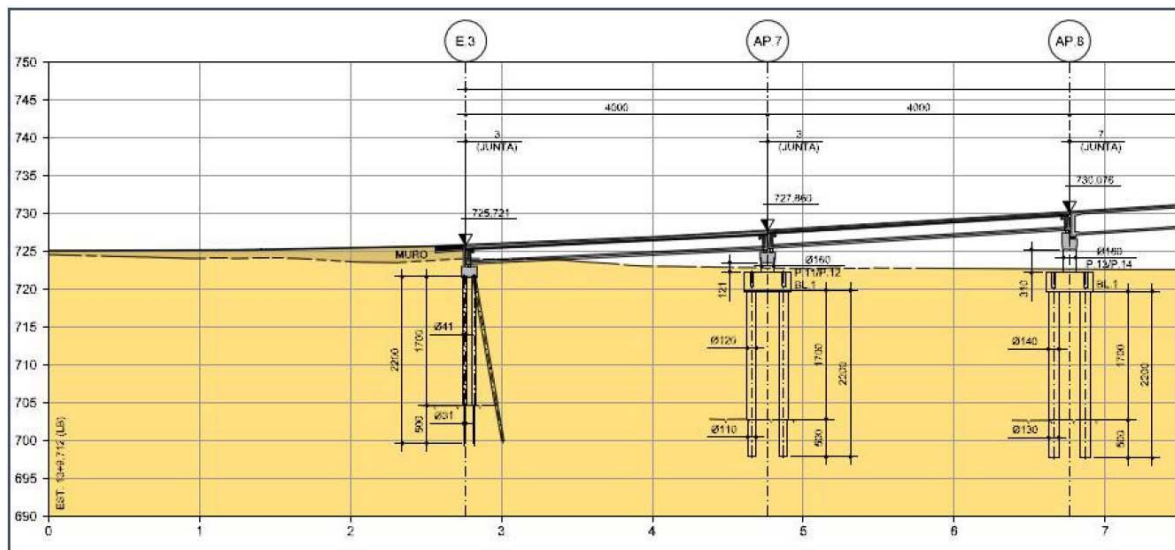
Perfil longitudinal da OAE – pista direita 1/4.
